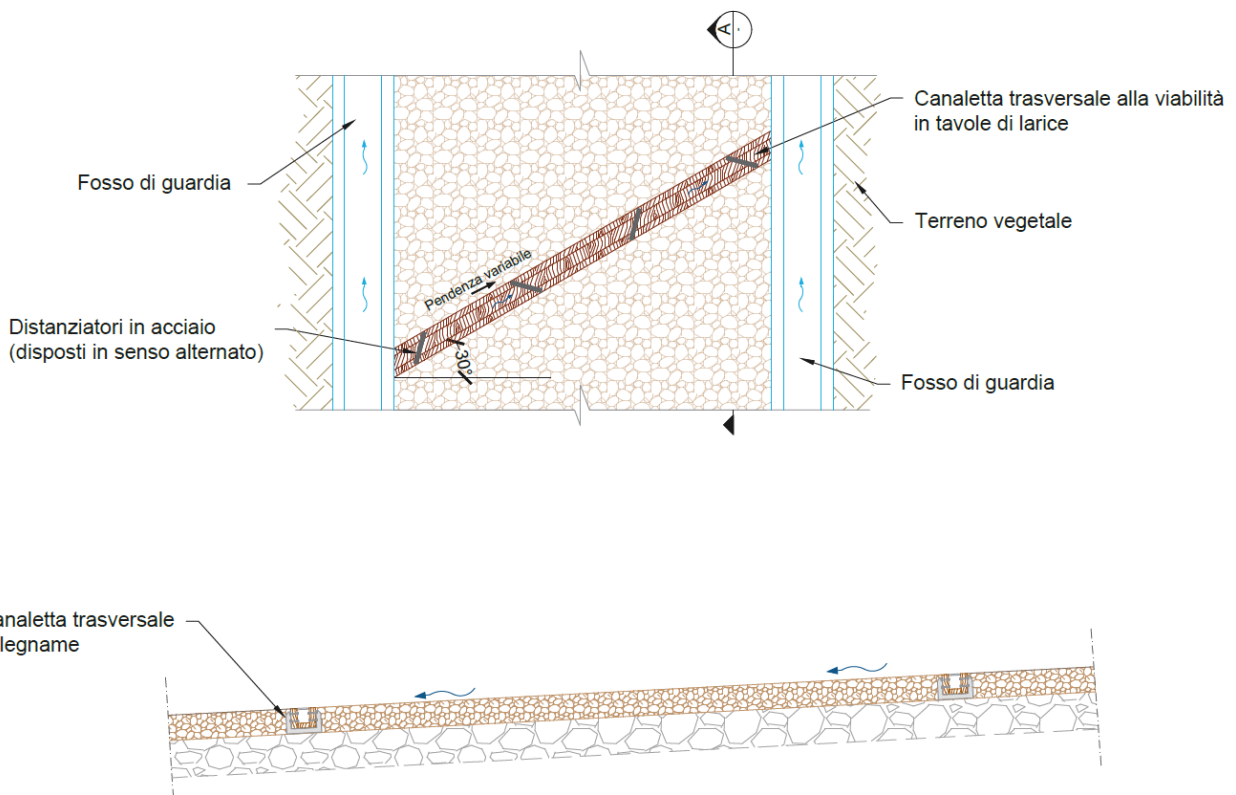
Tagli trasversali alla viabilità e sezione longitudinale AA con individuazione delle canalette in legname
